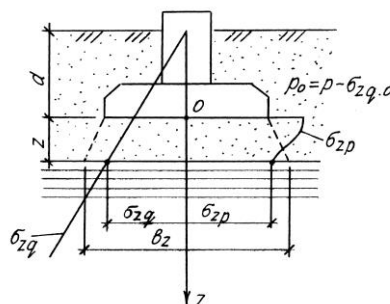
Схема к проверке слабого подстилающего слоя
